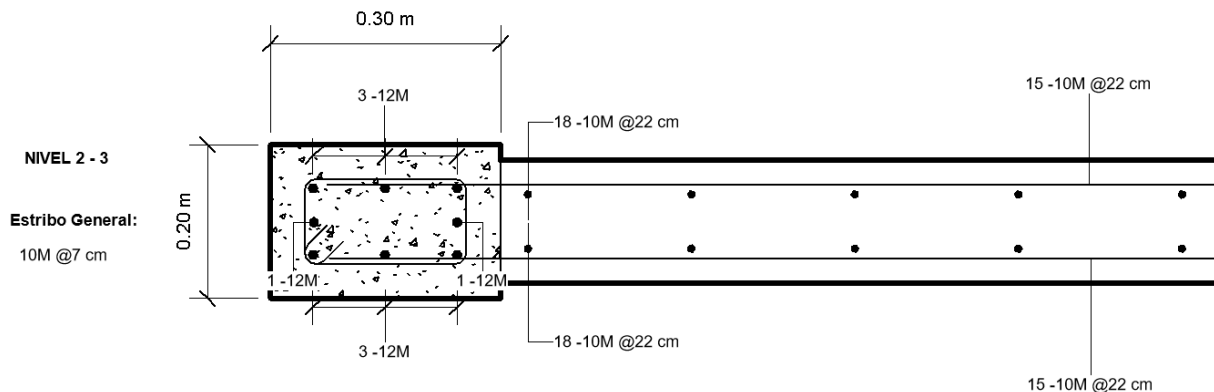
Secciones y armado de refuerzo cuando no se requiere elemento de borde para el sistema de 3 pisos
